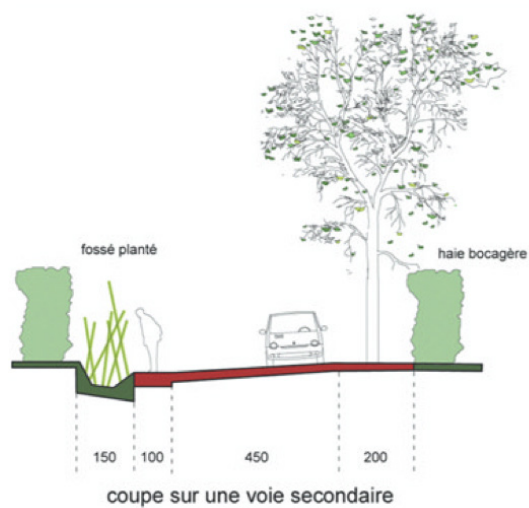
Varier le traitement du profil des voies et favoriser l'infiltration des eaux de pluie (CAUE de la Nièvre, 2006, p.2)
